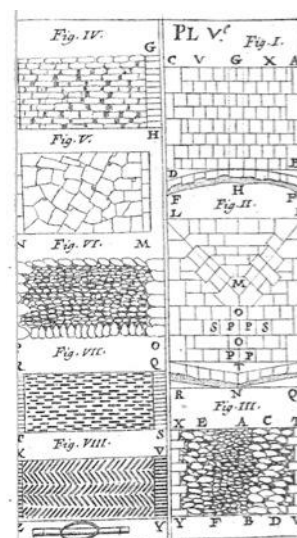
> Descripción de los distintos pavimentos empleados en la pavimentación (Gautier 1693)
